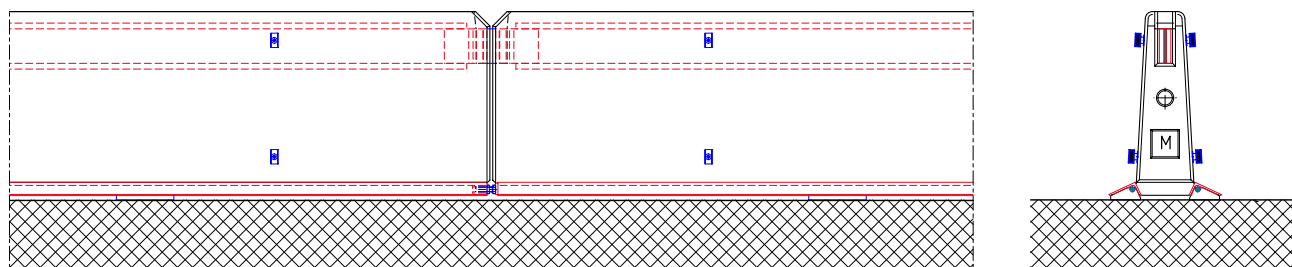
| Systemöversikt. Utdrag ur installationsritningen K706600.
